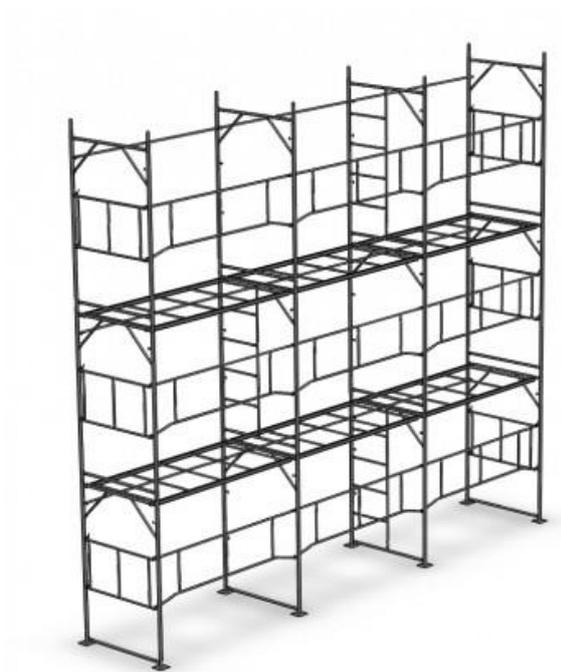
Execução do revestimento externo em argamassa com andaime fachadeiro
